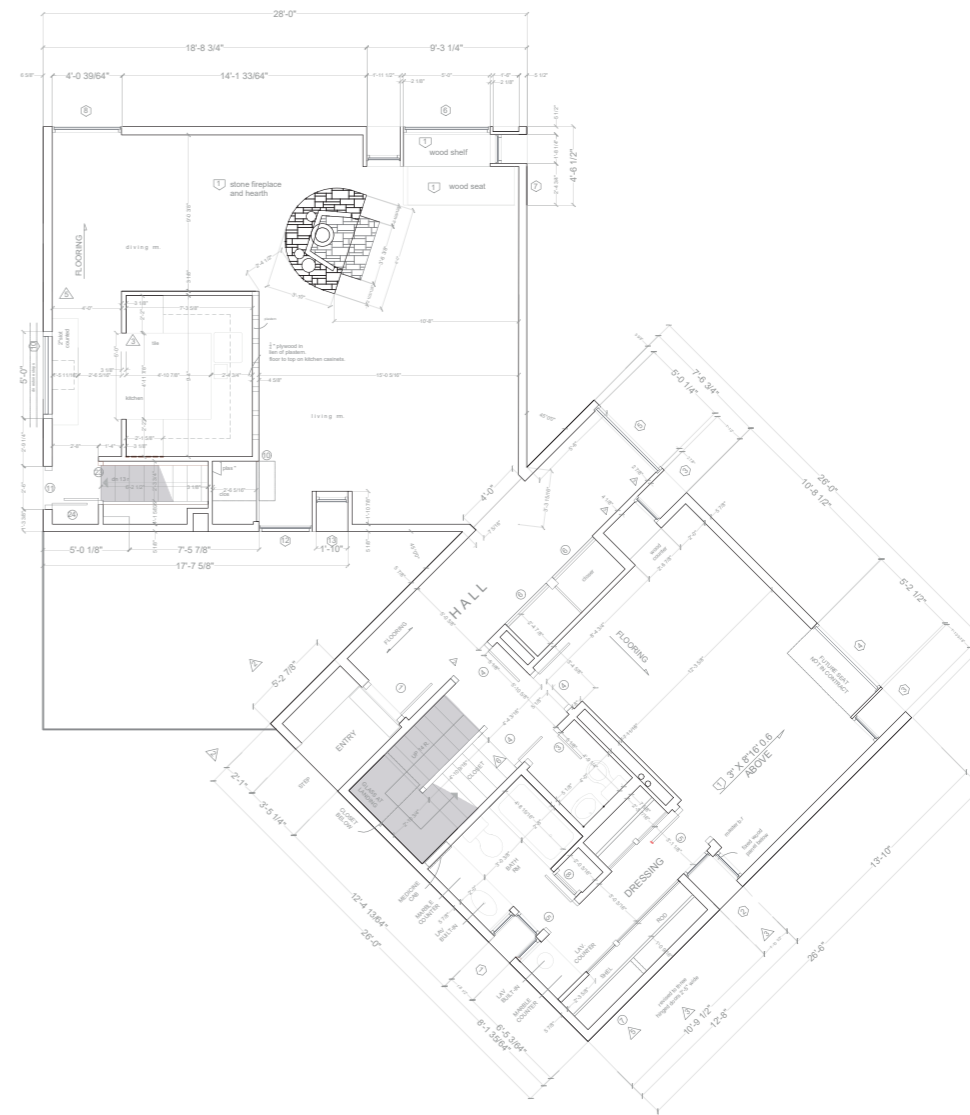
Plano de planta principal de entrada realizado con AutoCAD a partir de la documentación original de la Fisher House. e 1/125
